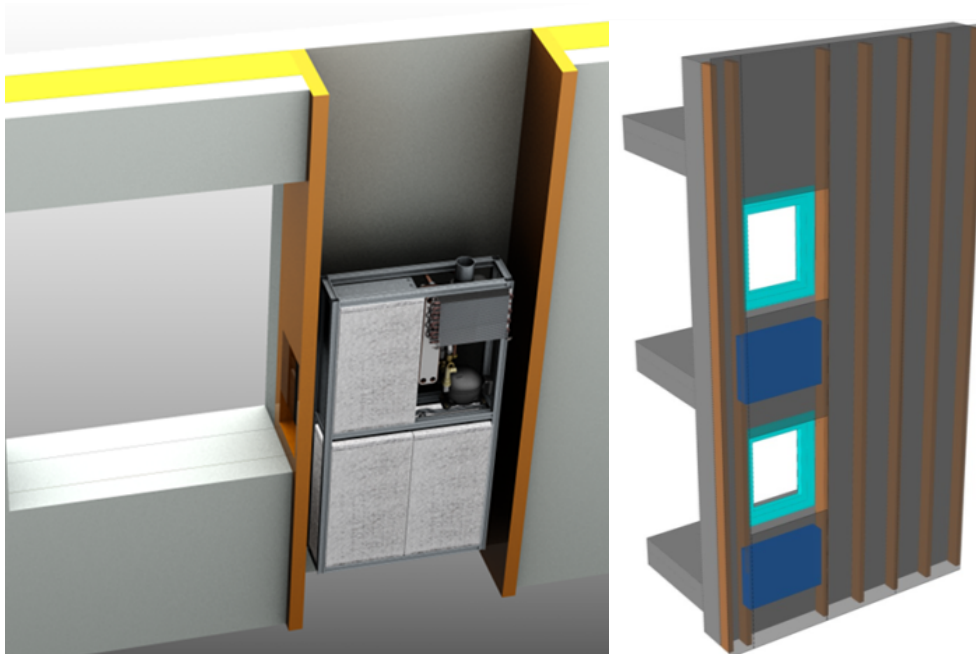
Integrationsmöglichkeit in einer Vorhangfassade: Speicher und Wärmepumpe in einen Installationsschacht neben dem Fenster (links, Bildquelle: Vaillant) bzw. Speichereinheit unterhalb des Fensters (rechts, Bildquelle: Kulmer Holzbau)
